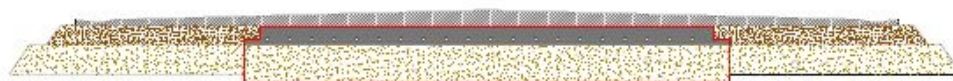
Sezione in rilevato con vecchia pavimentazione
